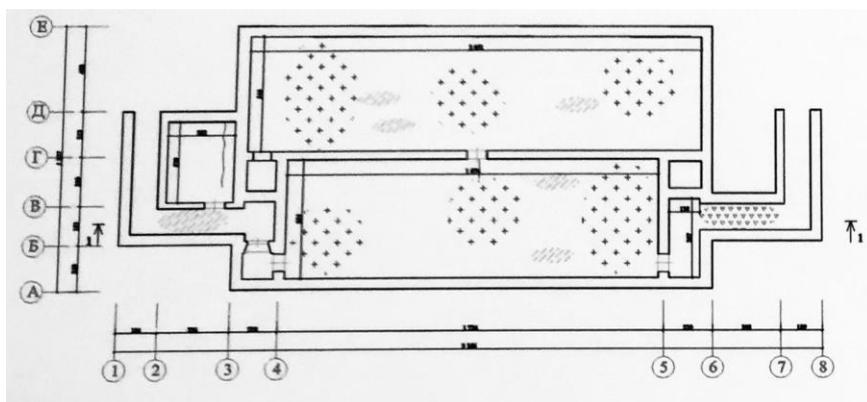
План перекрытия сооружений с указанием дефектов.
